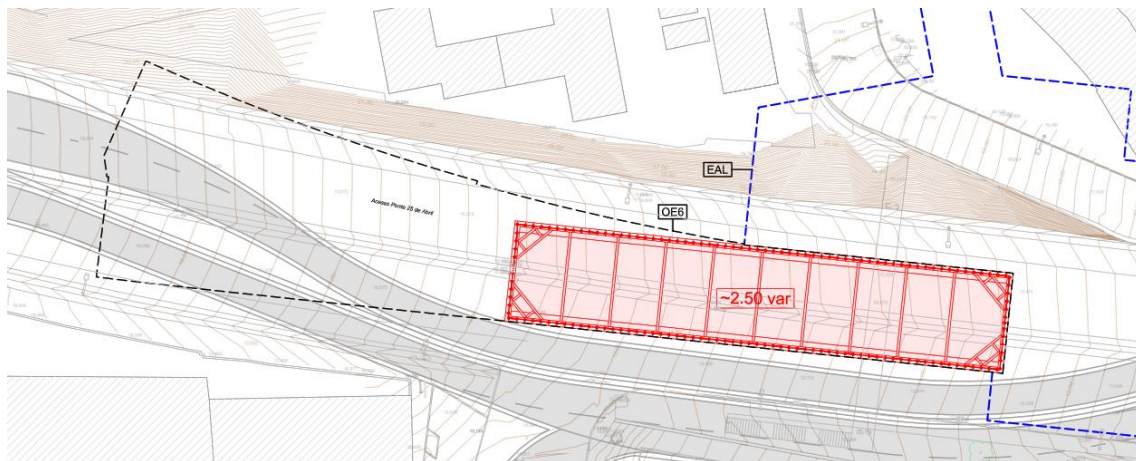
Planta de Dimensionamento Contenção Provisória – 1ª Fase de escavação
